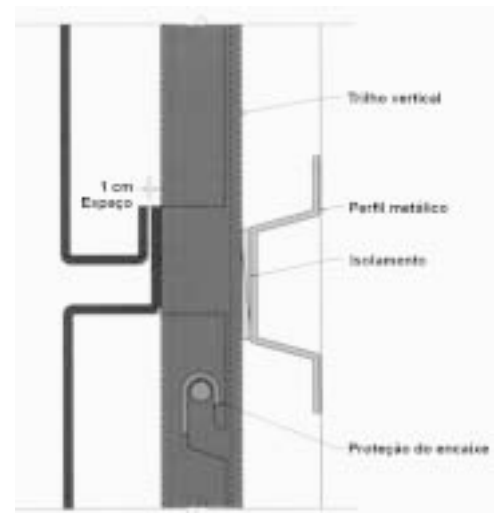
Corte de junta horizontal de sistemas em painéis perfilados (cedida pelo fabricante – UNA CLAD).
